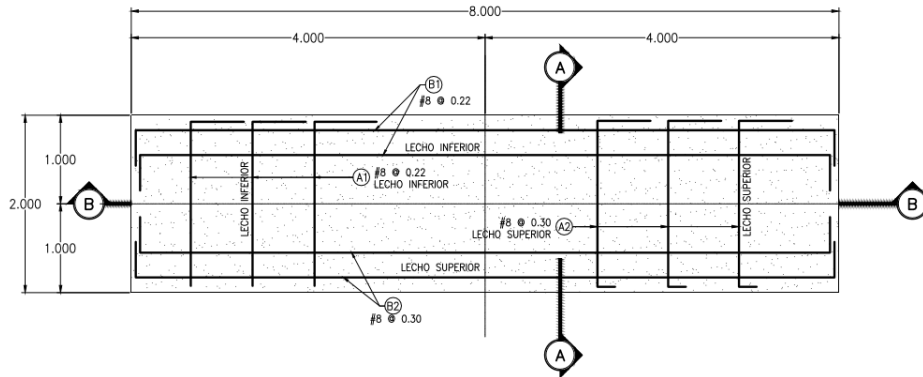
Detalle estructural de cimentación de estribo, 2da calle.
